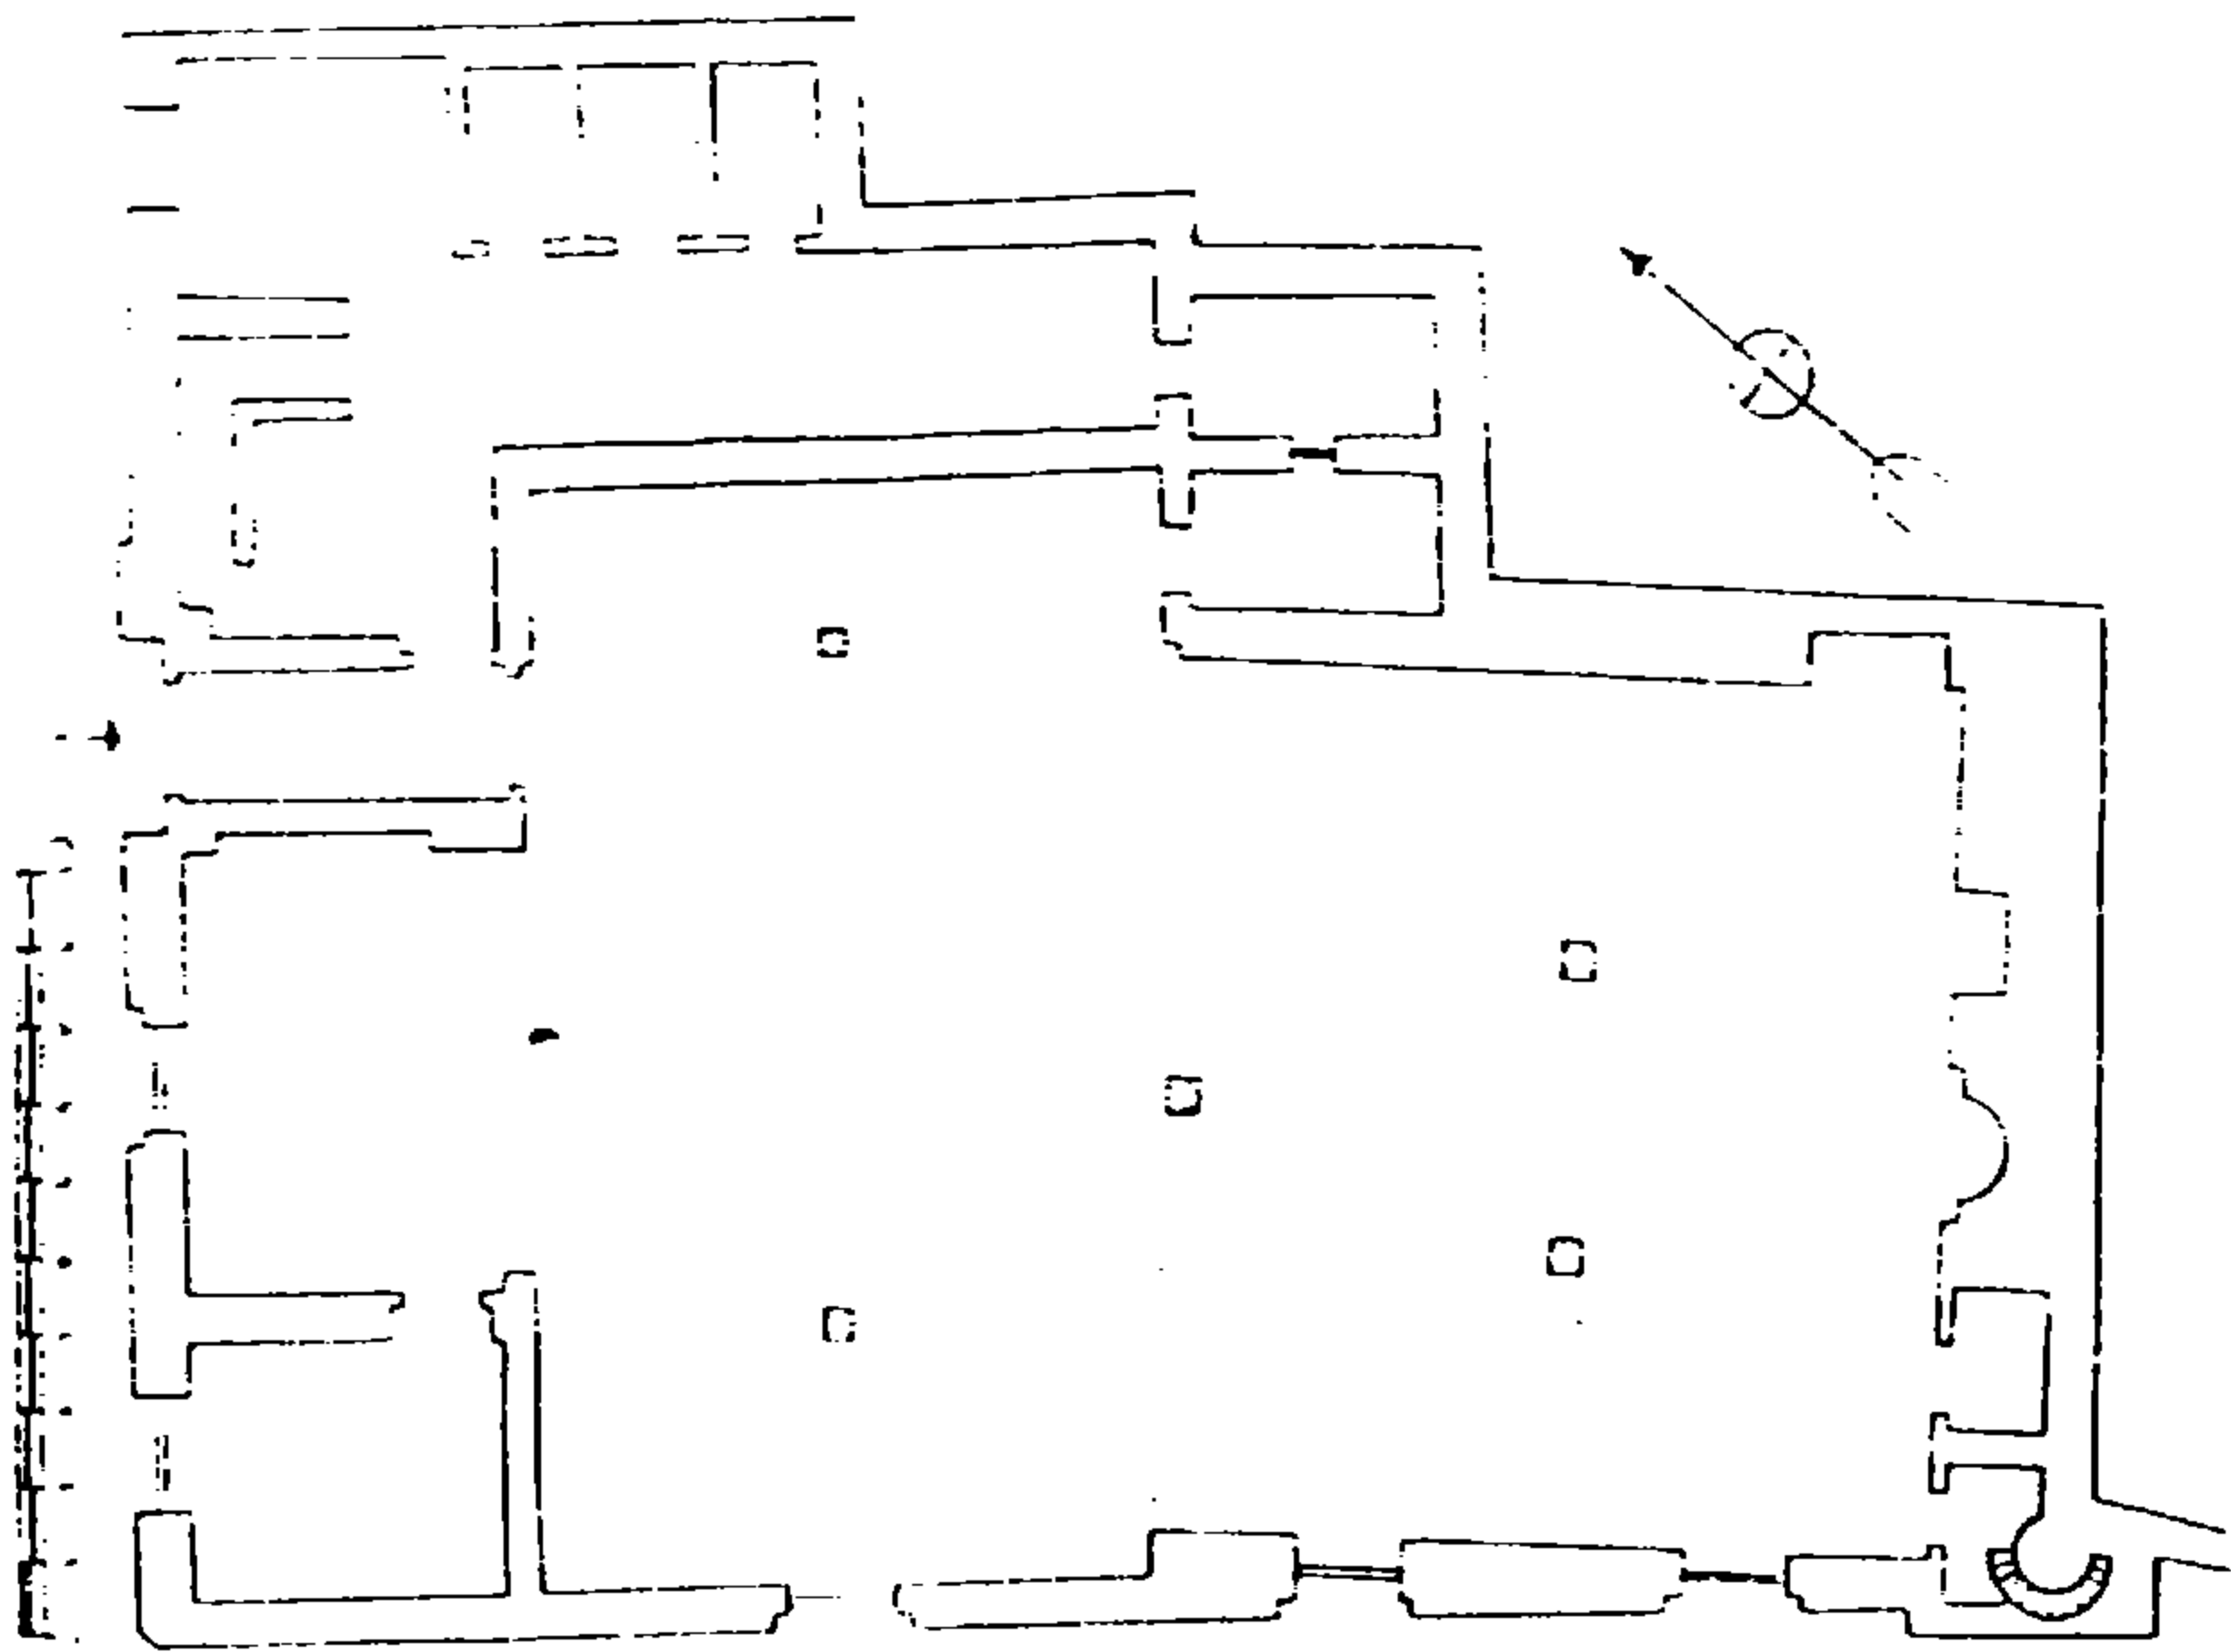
المسقط الأفقى لجامع الشيخ رمضان
